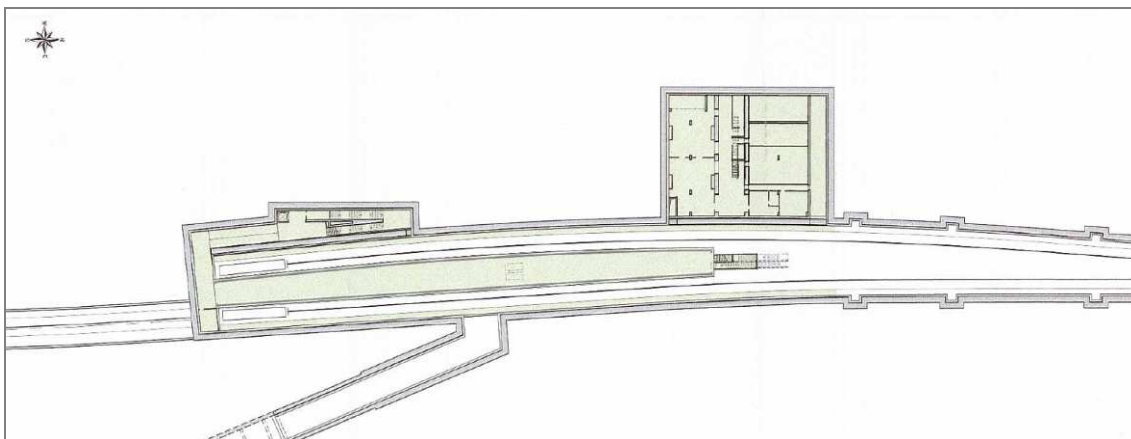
FASE 1 (Realizzazione opere interne: Strutture interne orizzontali e verticali)
